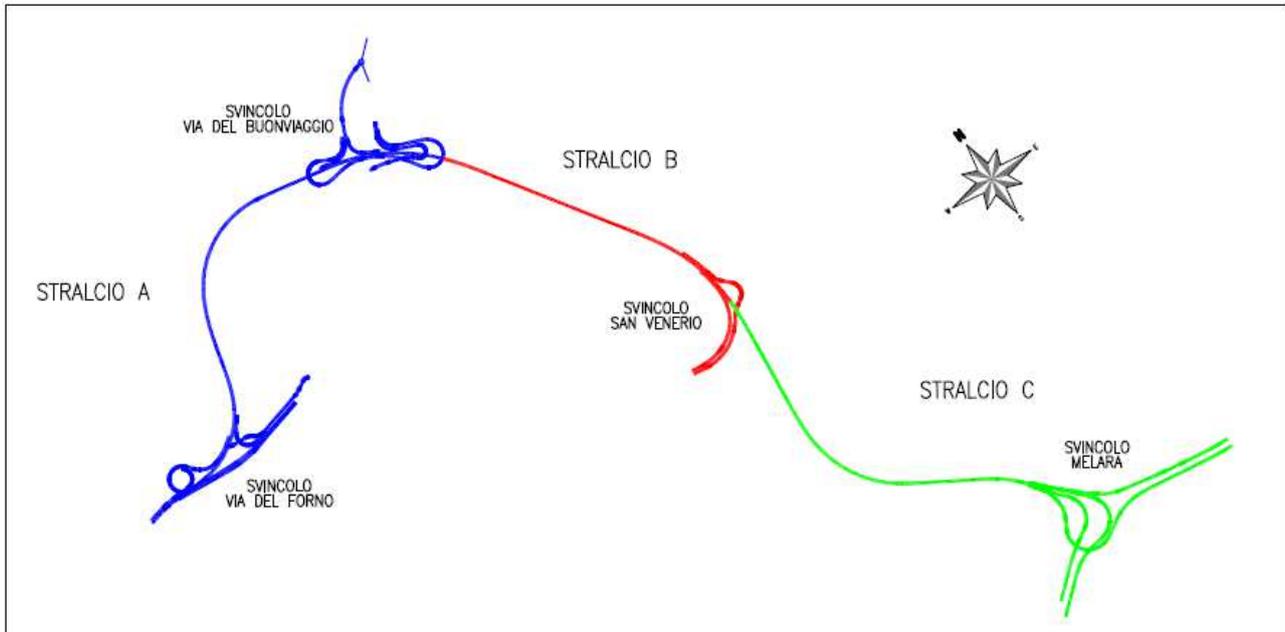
Planimetria Lotto 3 - Suddivisione in Stralci funzionali
